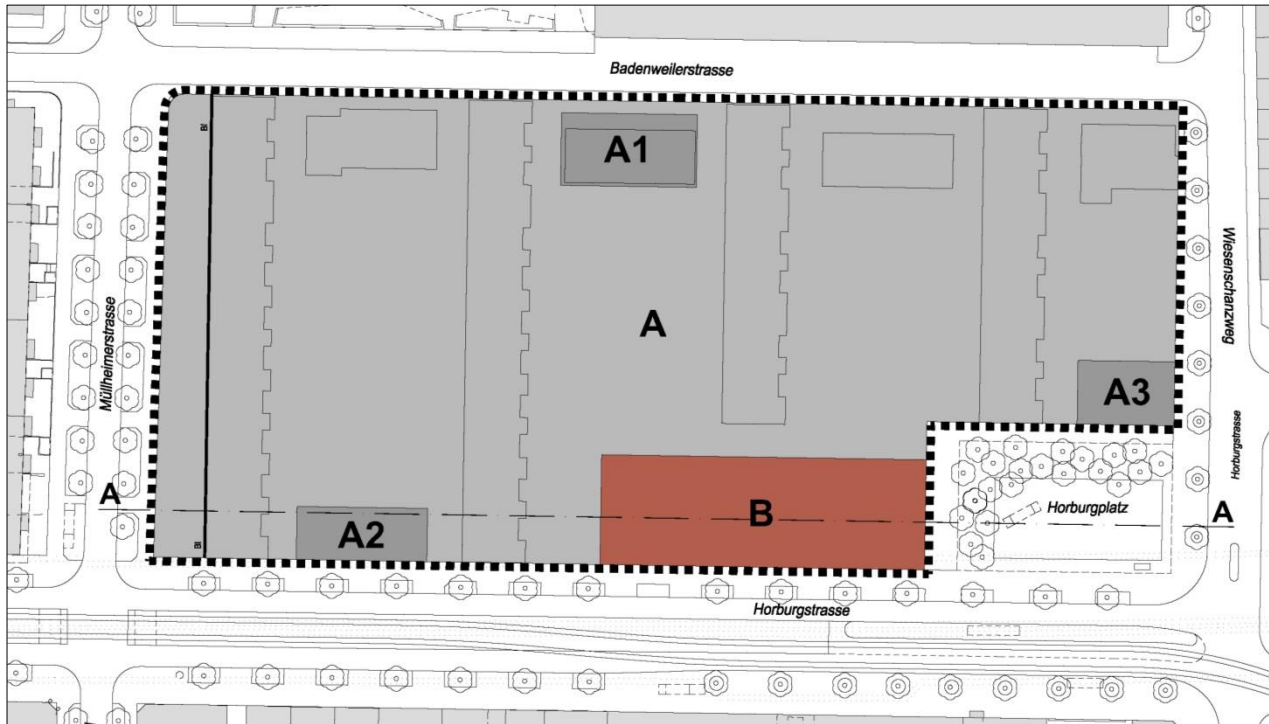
Bebauungsplan Nr. 14'281, Situation (kein Massstab, Plan genordet)
